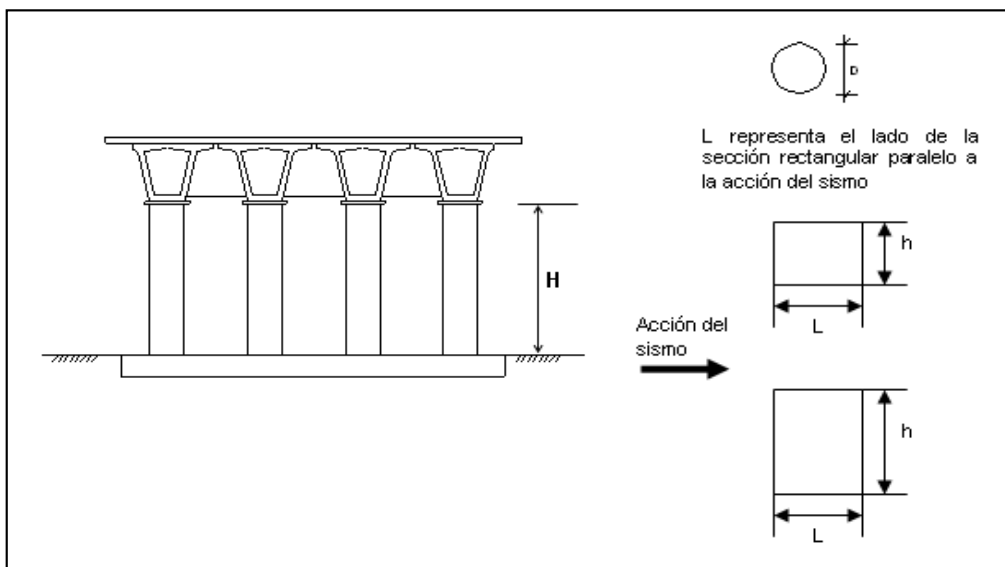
Puentes con columnas aisladas en voladizo, cimentados sobre suelo firme
